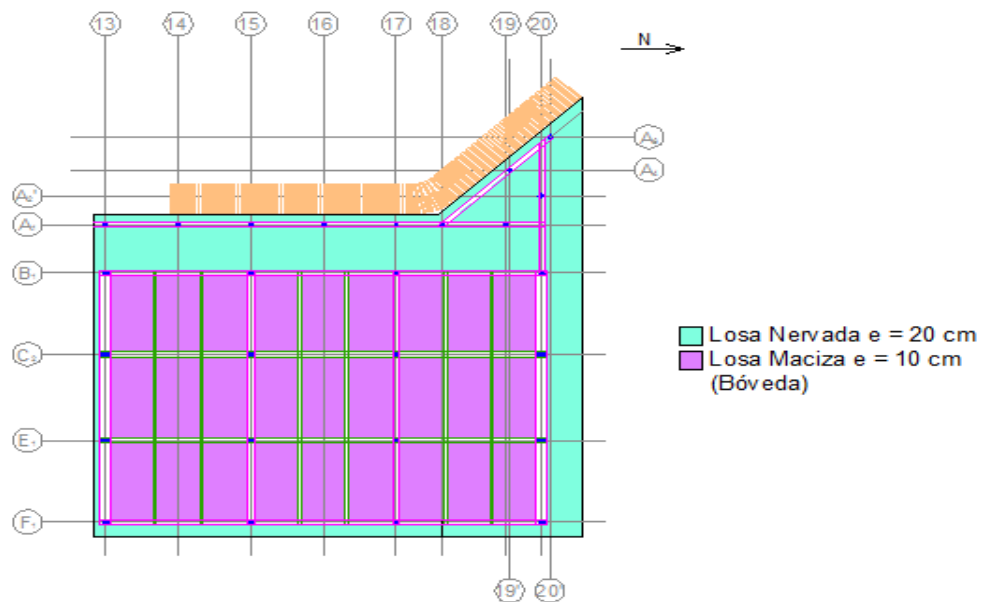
Ubicación de las losas de techo en Estructura Original. Área de Entrega de Comida.
